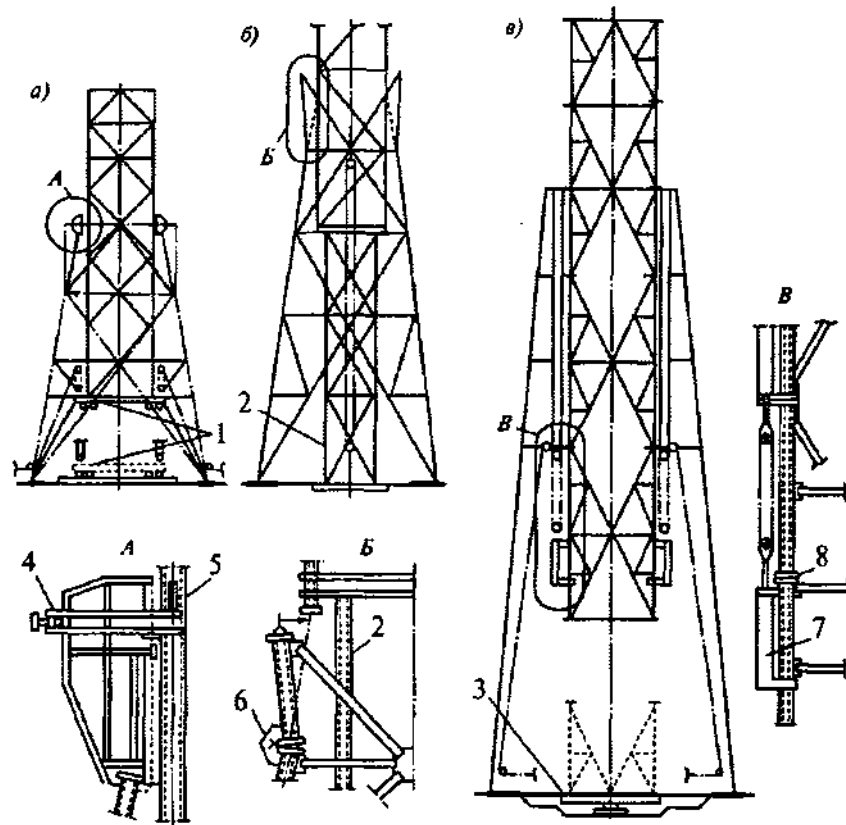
Схема виштовхування верхніх частин баштової споруди при підрощуванні: а - з обпиранням частини, яка виштовхується, на опорні пристрої; б - з інвентарним хвостовиком і розворотом поясів; в - з вертикальними захоплювачами; 1 - стенд підйомно-тягової системи; 2 - висувна опорна балка; 3 - опорний столик; 4 - хвостовик; 5 - шарнір; 6 - хрестовина; 7 – вертикальний захоплювач; 8 - фланцеве з'єднання
